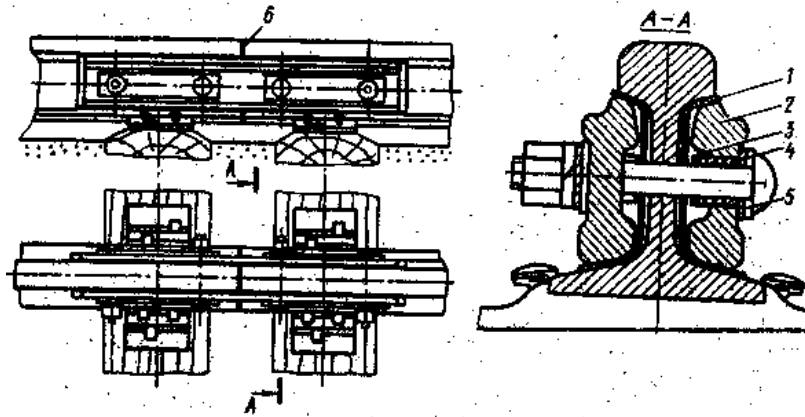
Изолирующий стык с двухголовыми металлическими накладками для пути деревянными шпалами:
